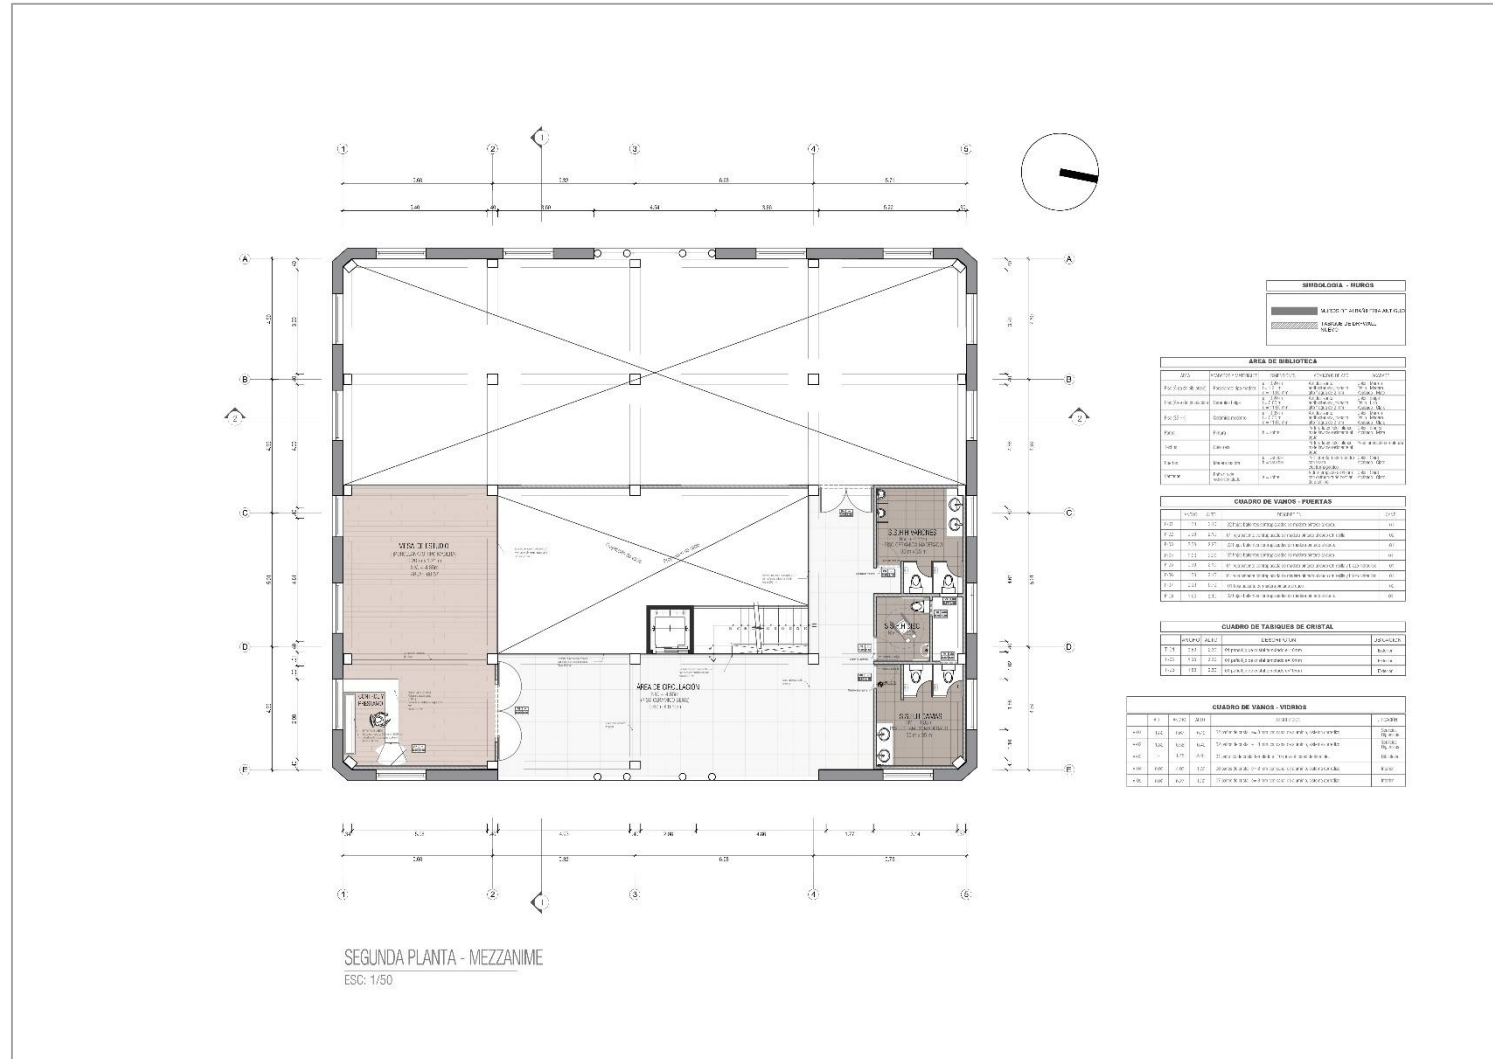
Segunda planta - mezzanine arquitectura, escala 1:50
